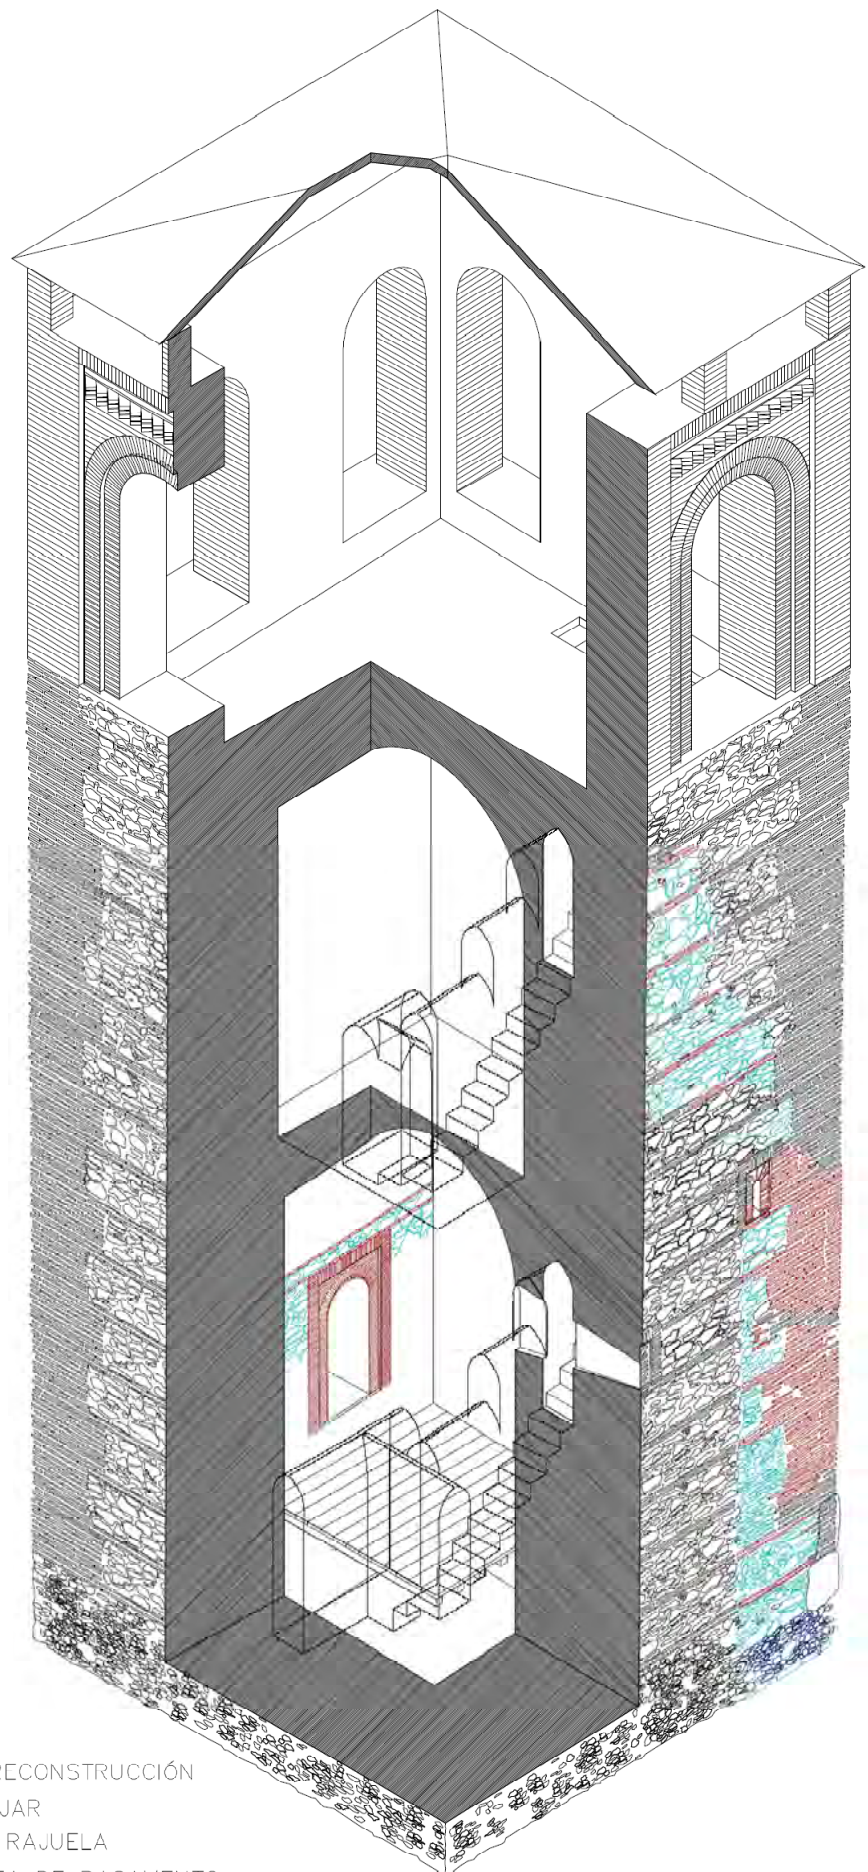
axonometría seccionada con hipótesis de reconstrucción. Se aprecian las dos cámaras y la estructura de escaleras encastradas en el muro que las comunica.
